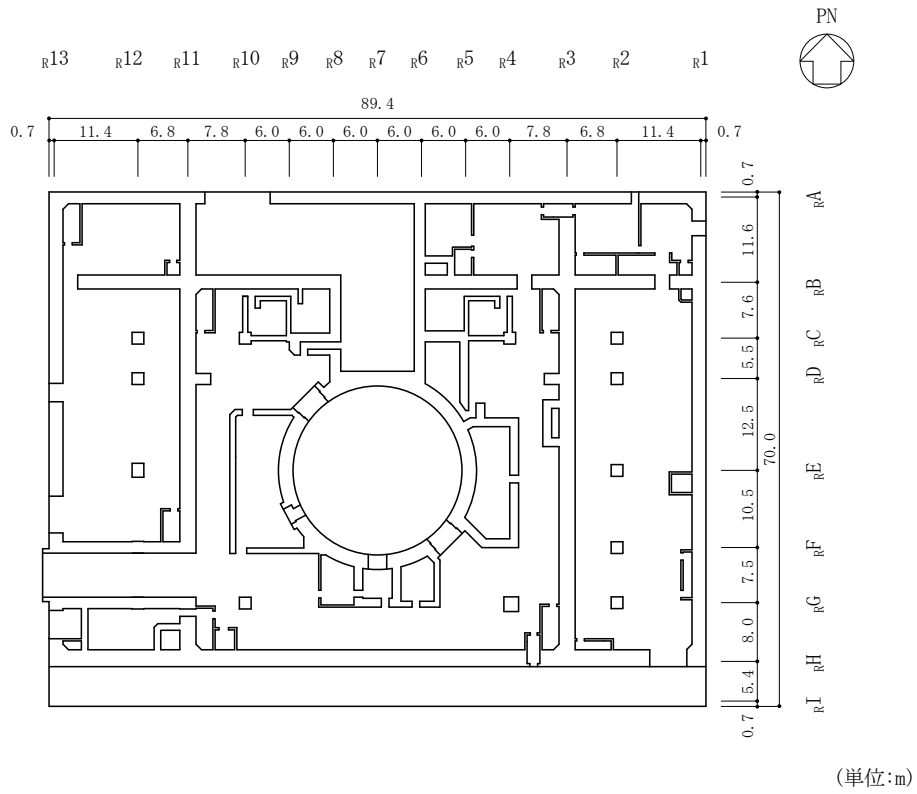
(3) 原子炉建物の概略平面図 (EL 15.3m)
